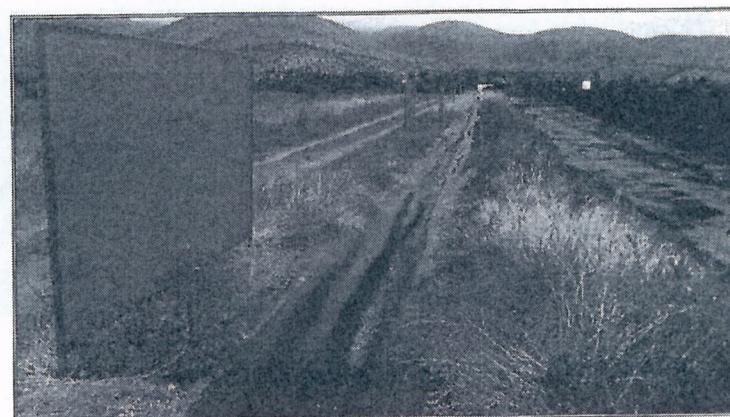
Estado actual Canal perimetral norte de oriente a poniente.
